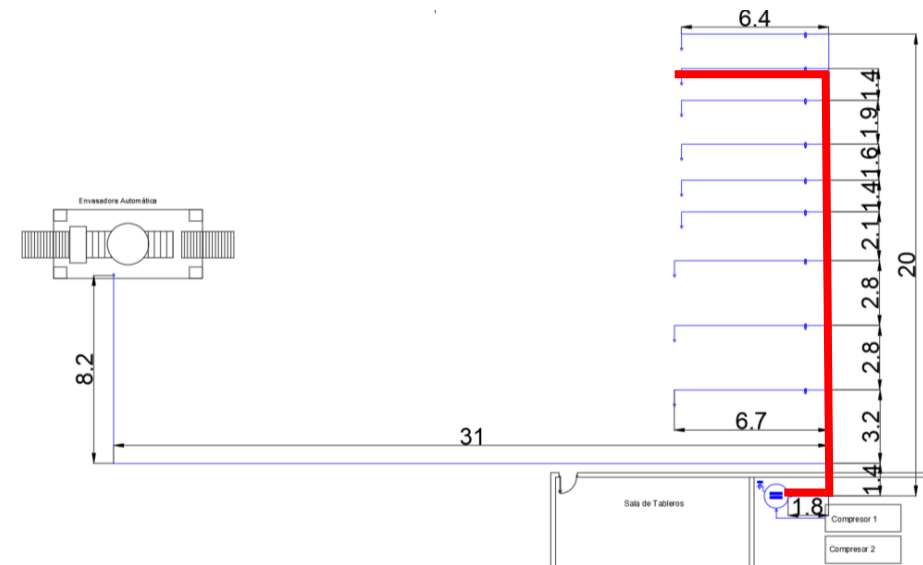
Layout verificación 10 de cañería de aire comprimido
